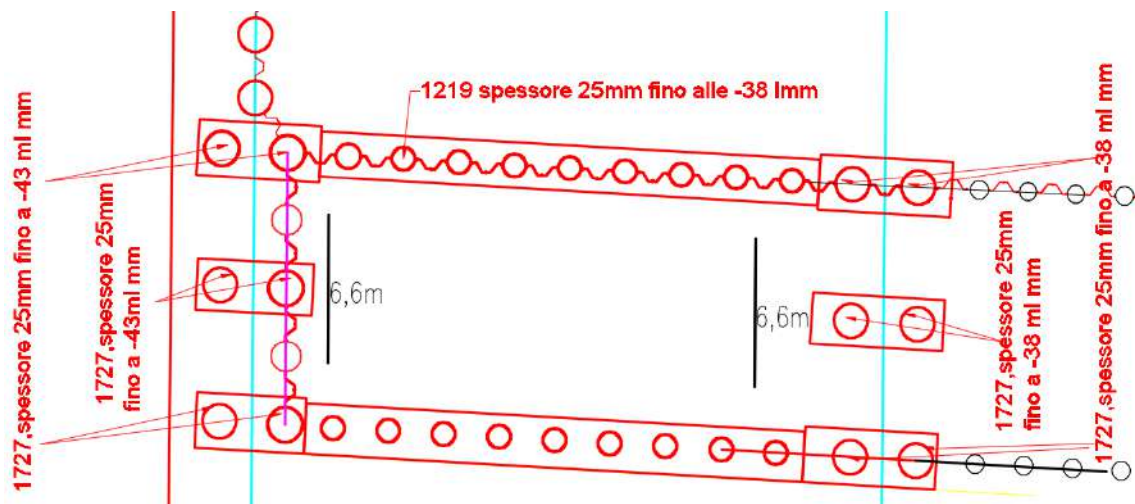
vista planimetrica delle strutture di fondazione (canale fossa Melara)
